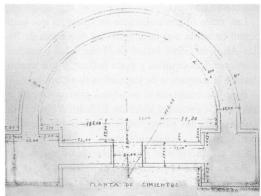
Planta de cimientos de la ría de la Plaza de España. (Archivo de FIDAS, Sevilla)
